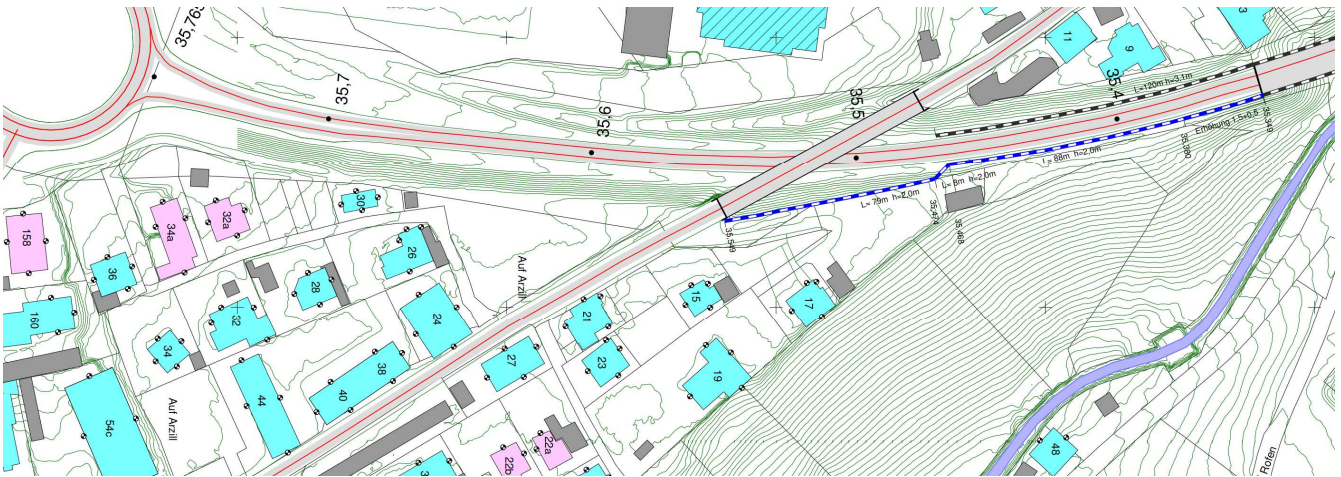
Übersichtslageplan mit baul. Schallschutz V03, Auszug aus Plan H016_32 /6/
